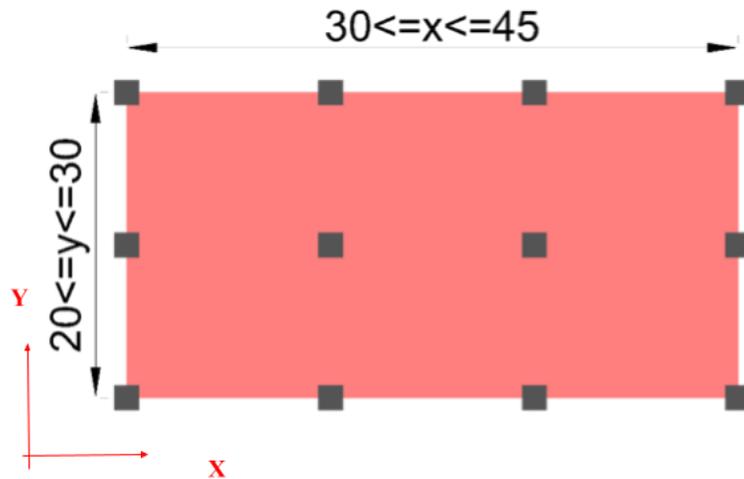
Ejemplos de planta tipo. (Dimensiones en cm)
